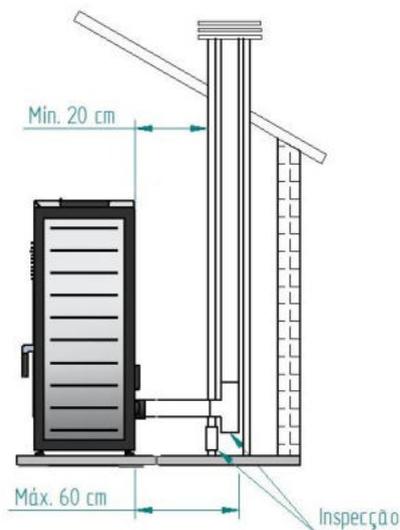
Vista lateral da instalação com chaminé, com exemplo do ponto de inspecção.
